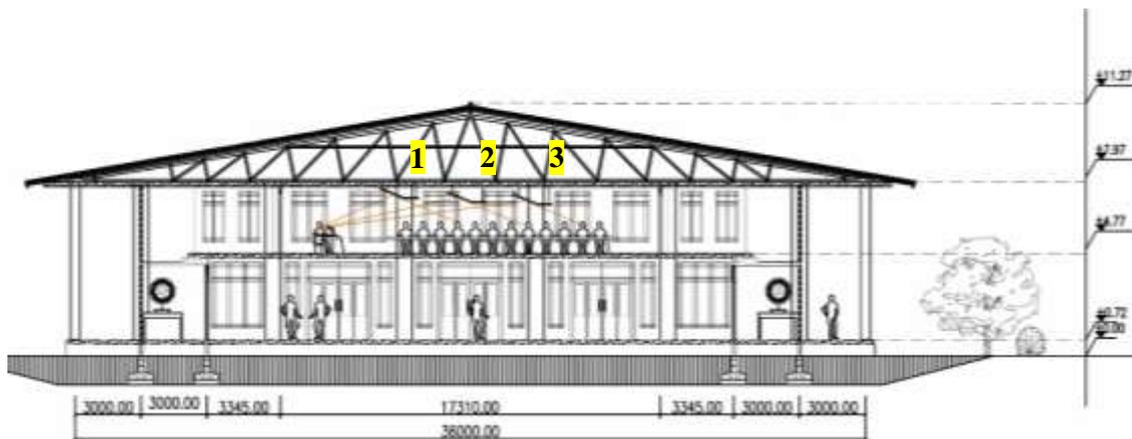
Rekomendasi desain penambahan elemen gantung pada plafond di ballroom
